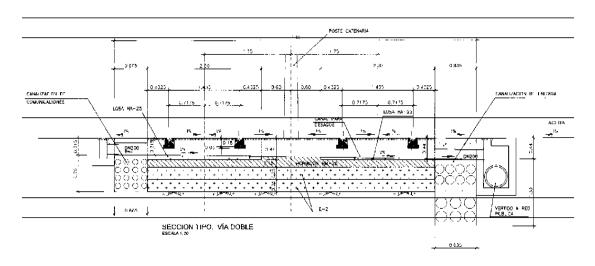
Sección de vía doble con elastómero entre pavimento y carril
